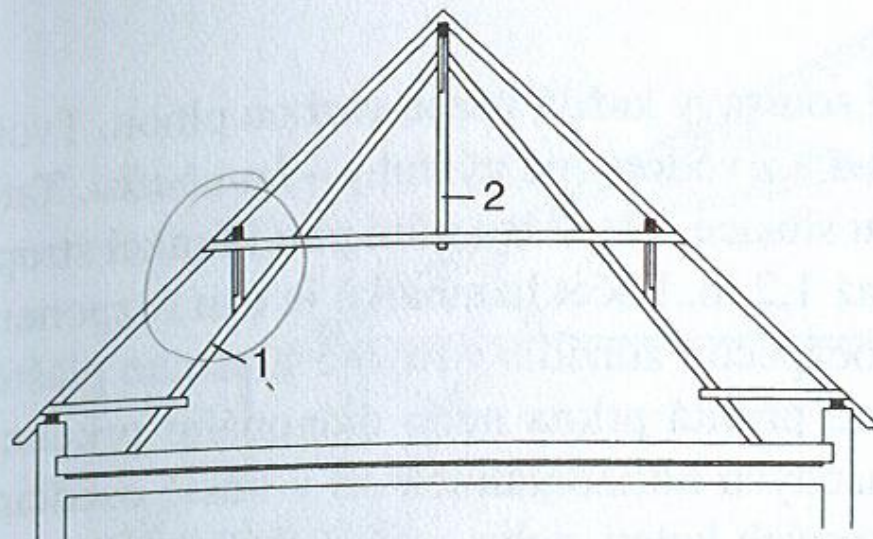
Plná vazba dvojitého věšadla pro sedlovou střechu s rozponem 10 až 12 m: 1 – šikmá vzpěra, 2 – rozpěra, 3 – zdvojený sloupek = věšák
